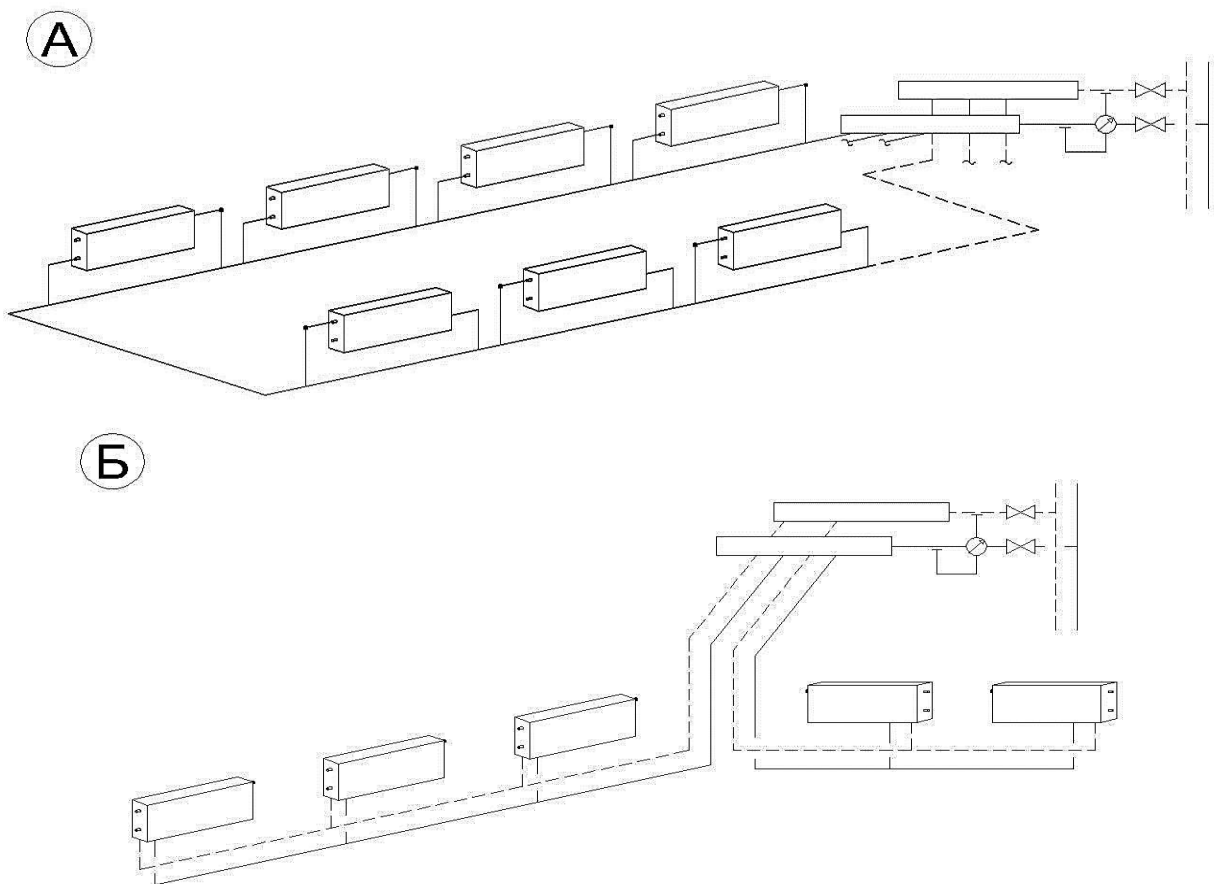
Схемы разводки трубопроводов периметральных систем квартирного отопления: А – однетрубная; Б – двухтрубная.
